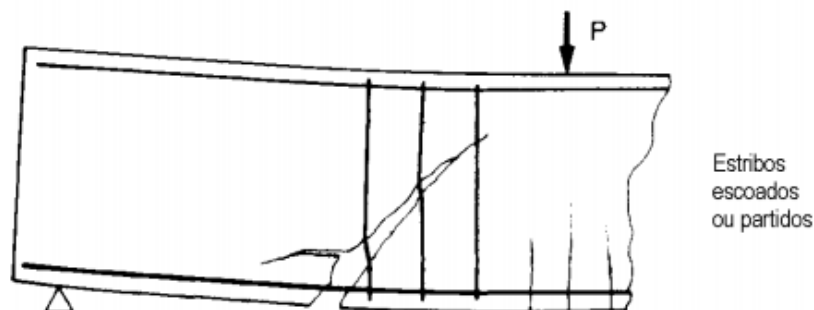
Fissura em uma viga causada pela falta de armadura transversal. Fonte: Leonhardt e Mönning (apud CARELLI, 2002).
